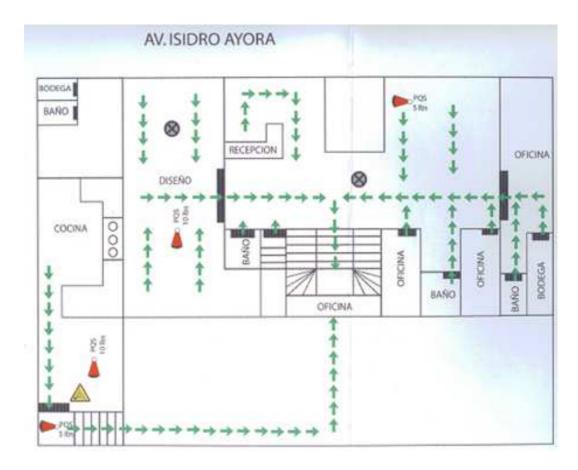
Layout Planta Alta (Fabicon, 2010)
